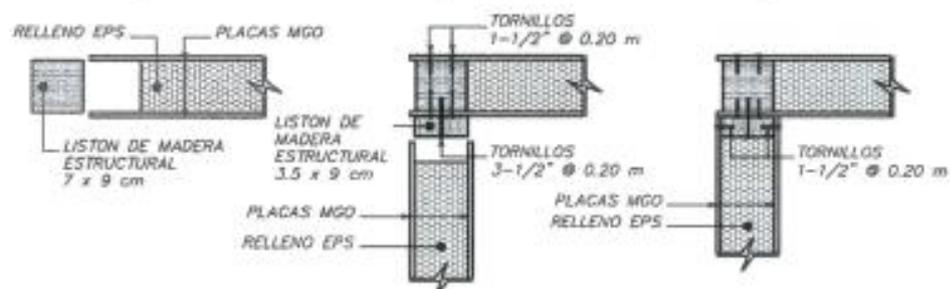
Unión entre dos paneles (conexión tipo "L"), vista en planta
